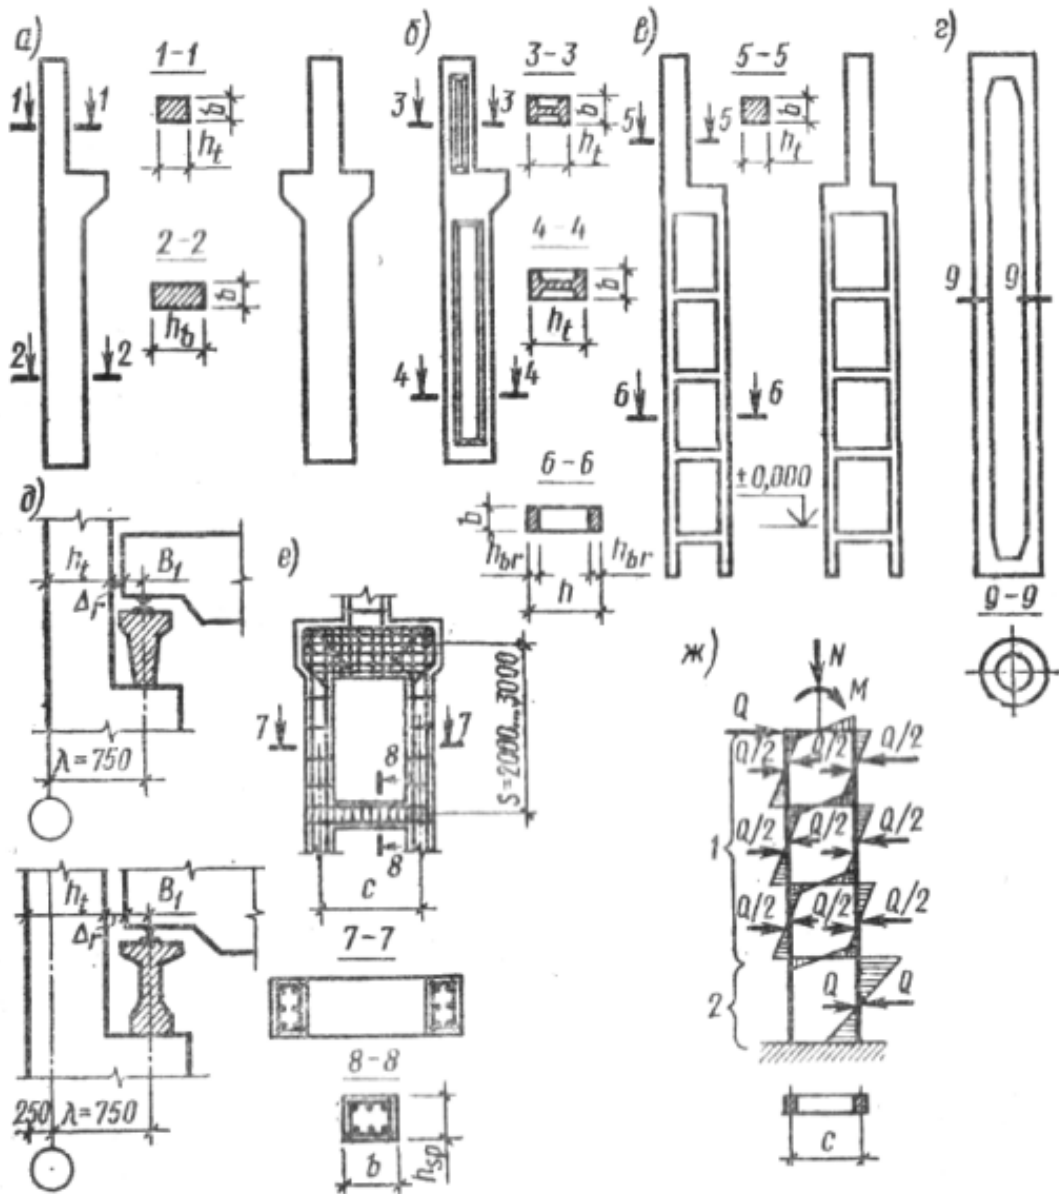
Конструкции колонн одноэтажных промышленных зданий с мостовыми кранами (а...в); центрифугированных колонн (г); к определению размеров сечений колонн (д)- армирование двухветвевой колонны (е)- к расчету двухветвевой колонны (ж): 1 — обе ветви сжаты; 2 — левая ветвь растянута
